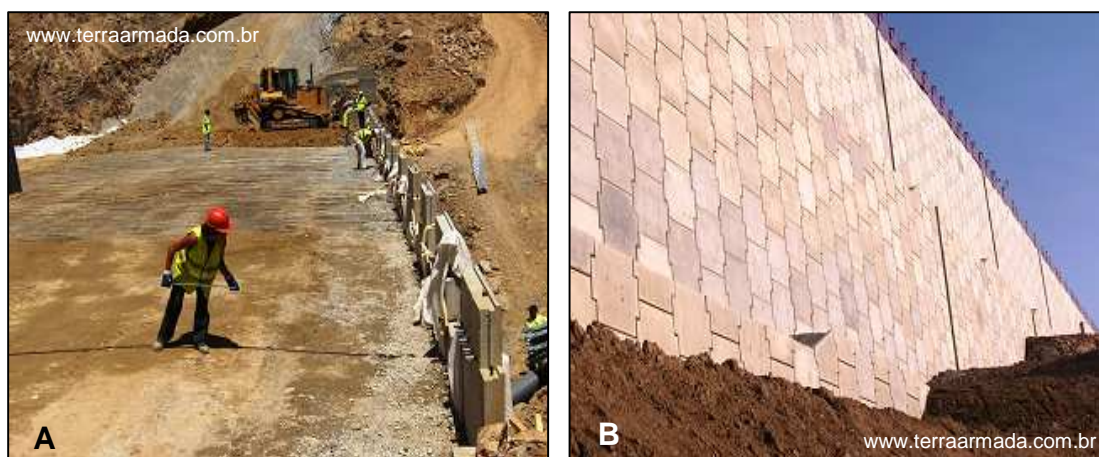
A – Construção de um muro de suporte do tipo terra armada. B – Aspecto do paramento exterior.
